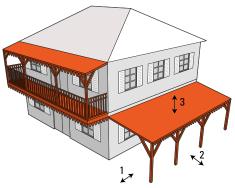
Rupture de pente entre auvent et toiture. Préférable
